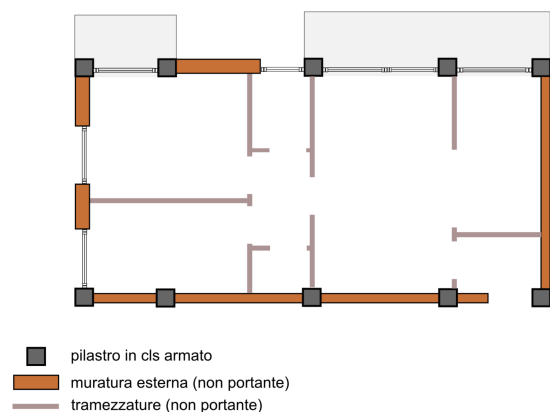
Pianta di un edificio ad ossatura in cls armato; osserva i pilastri e le grandi aperture; tutte le tramezzature possono essere demolite e ricostruite dove si vuole.
